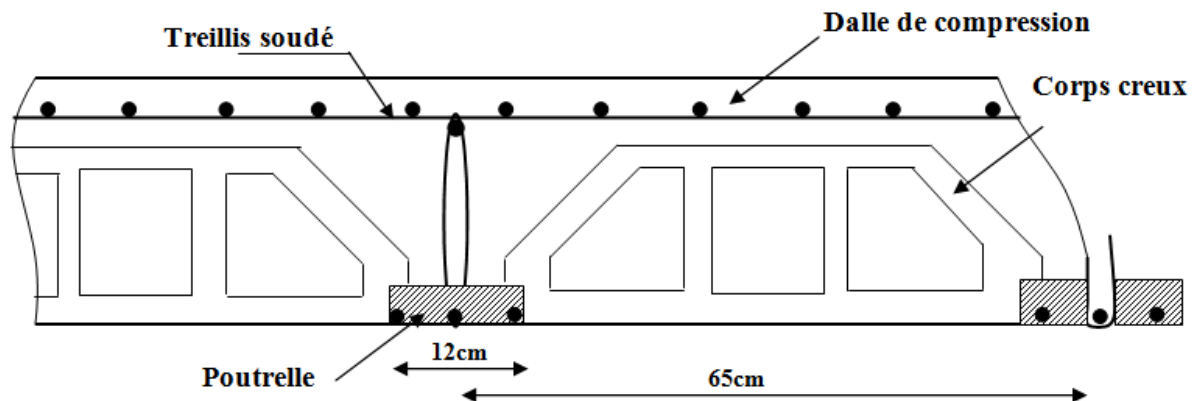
Coupe verticale d'un plancher en corps creux.
